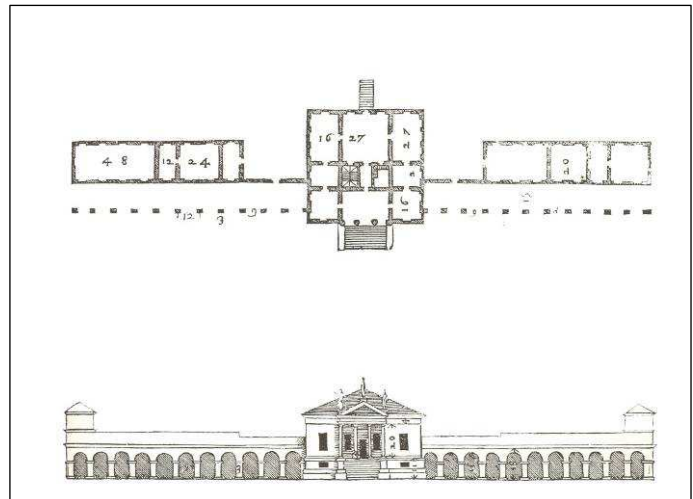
Villa Emo. Planta y alzado Planta y alzado Sur. Andrea Palladio, o.cit. Libro Secondo, pág. 55.
